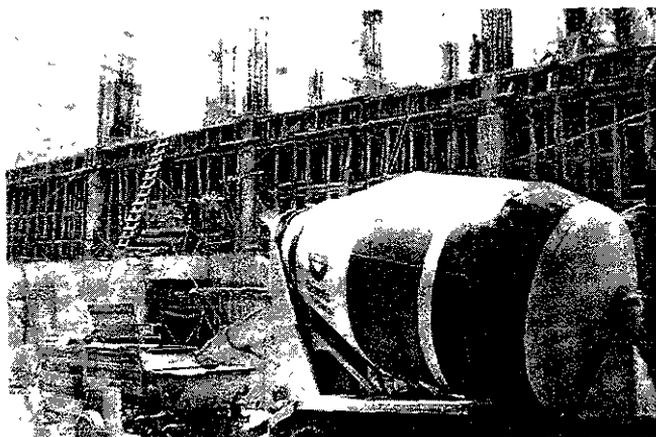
Bomba estacionaria (hidráulica) da una gran facilidad en la colocación del concreto. Se han bombeado sobre 427 m verticalmente y más de 1,400 m horizontalmente. De acuerdo con el equipo que se use, la capacidad de concreto varía de 8 a 120 m³ por hora.
